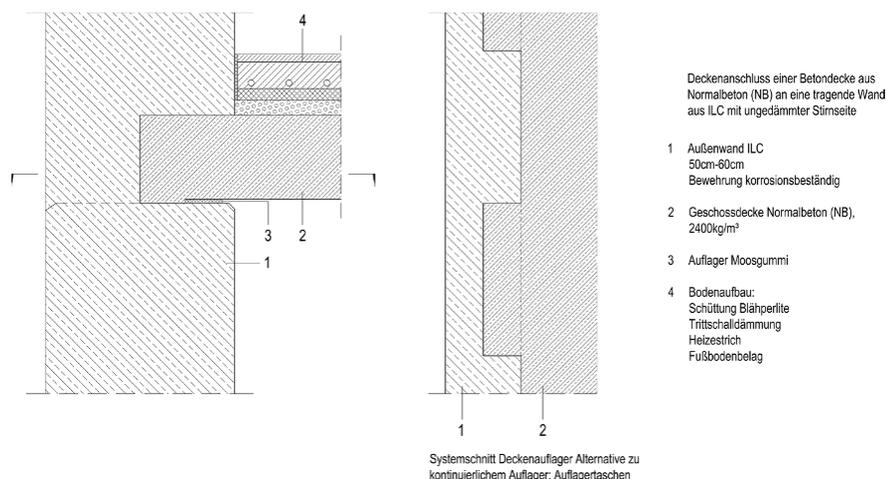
Deckenanschluss einer Betondecke aus Normalbeton (NB) an eine tragende Wand aus Infraleichtbeton (ILC) mit ungedämmter Stirnseite © ILC⁴⁹⁴
